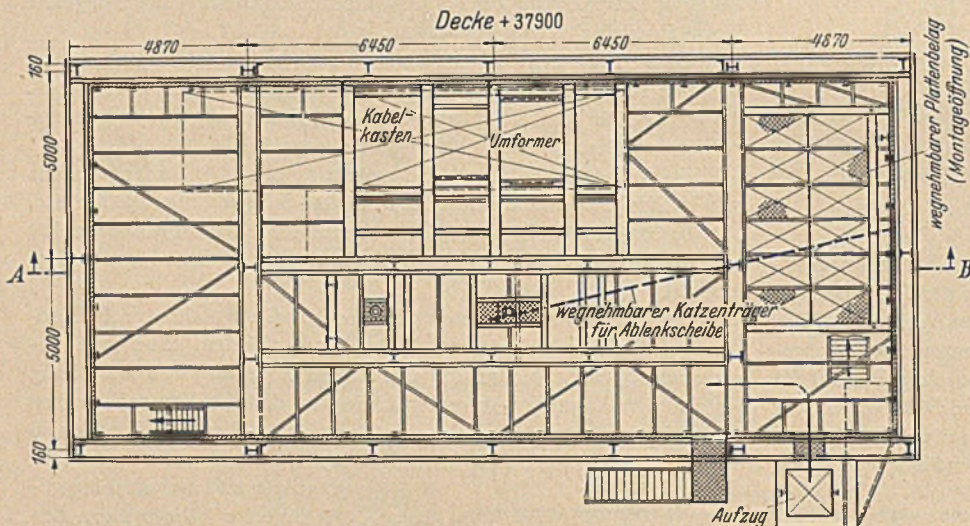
Grundriß des „Maschinenkellers“ (Bremsenbühne) mit Umformergruppe.
